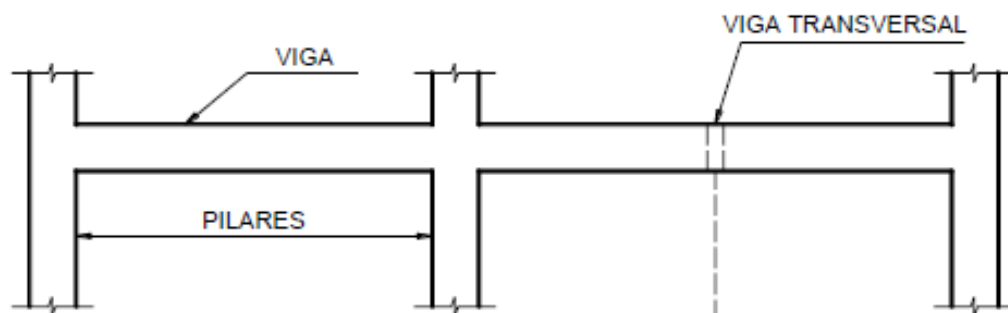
Vigas de concreto apoiadas sobre pilares. Fonte: Bastos (2019).
